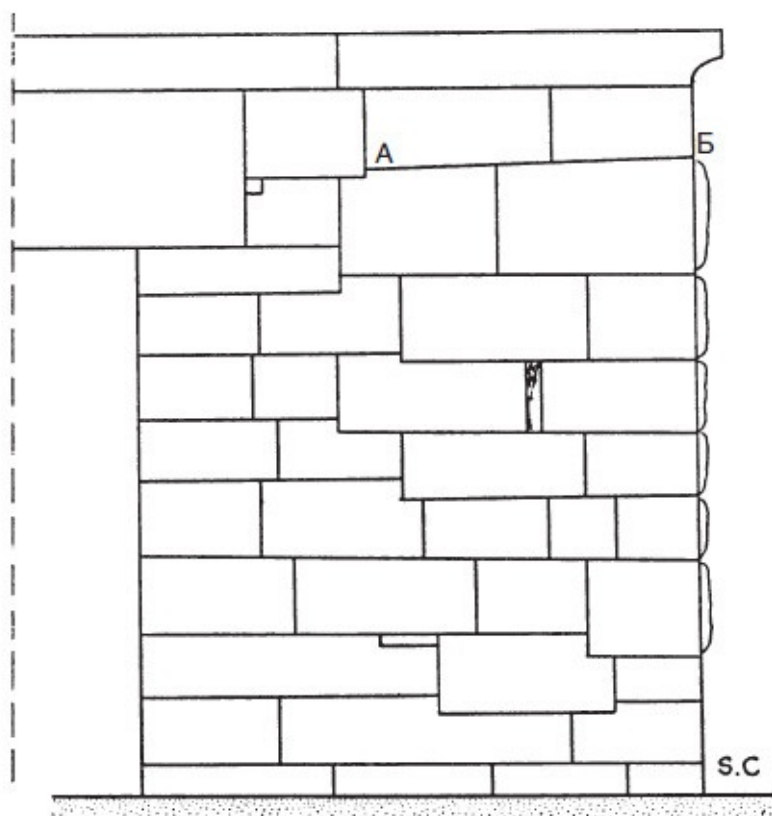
Кладка фасада небольшого храма Аменхотепа III в Эль-Кабе. Этот храм был сооружен из блоков неодинаковой высоты. Следует отметить, что горизонтальные швы некоторых блоков (АБ) имеют ярко выраженный наклон
